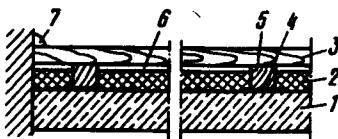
Утепление перекрытий с дощатыми полами по деревянным лагам, засыпным утеплителем или минеральной ватой
